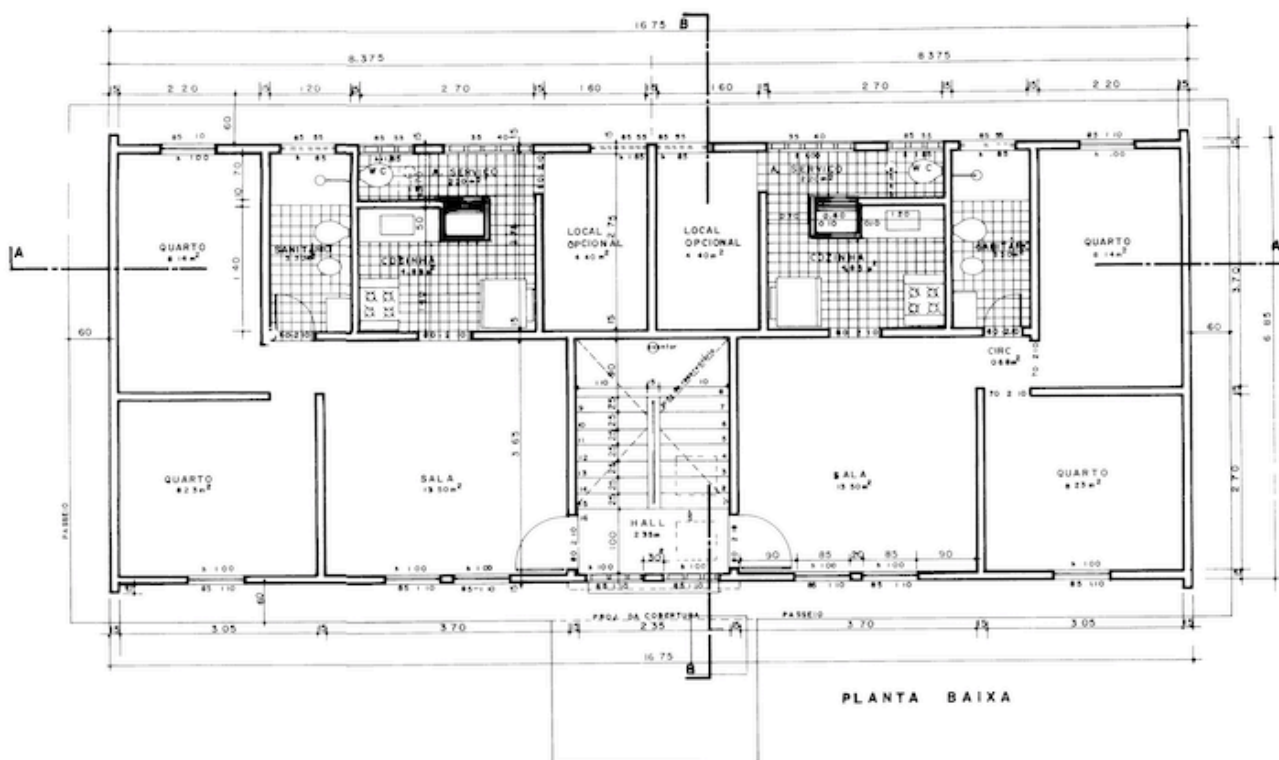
Planta do pavimento tipo do Conjunto Guilherme Marback, na Boca do Rio.
